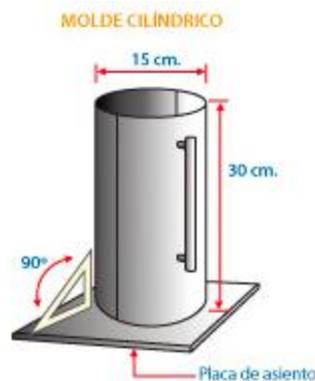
Molde Cilíndrico, Fuente: SENCICO
